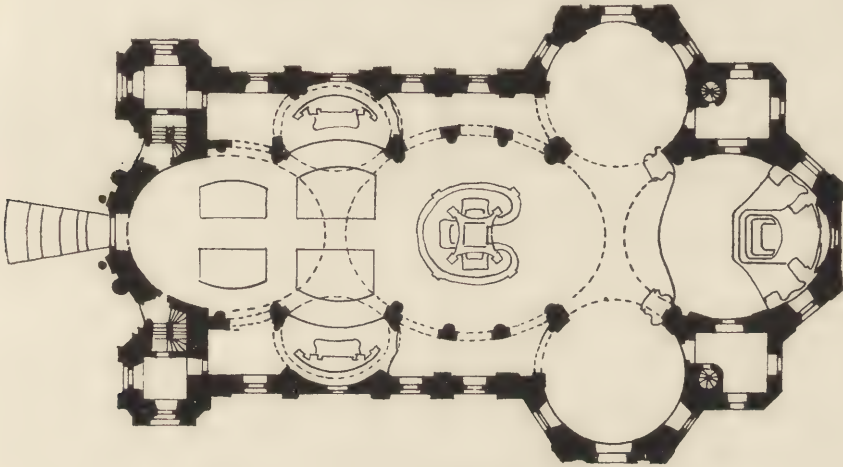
Kirche zu Vierzehnheiligen. Grundriss.
